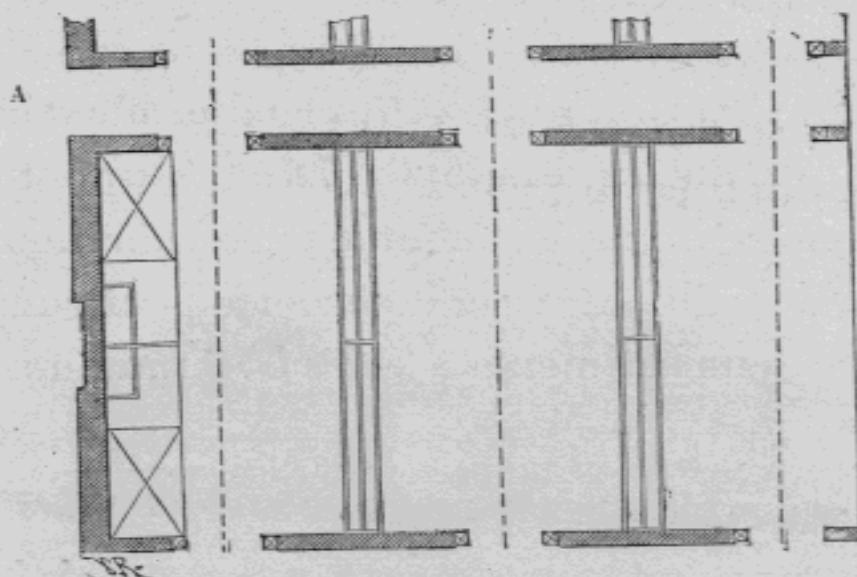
Plan d'une portion de la bergerie de M. le baron de Fourment.
